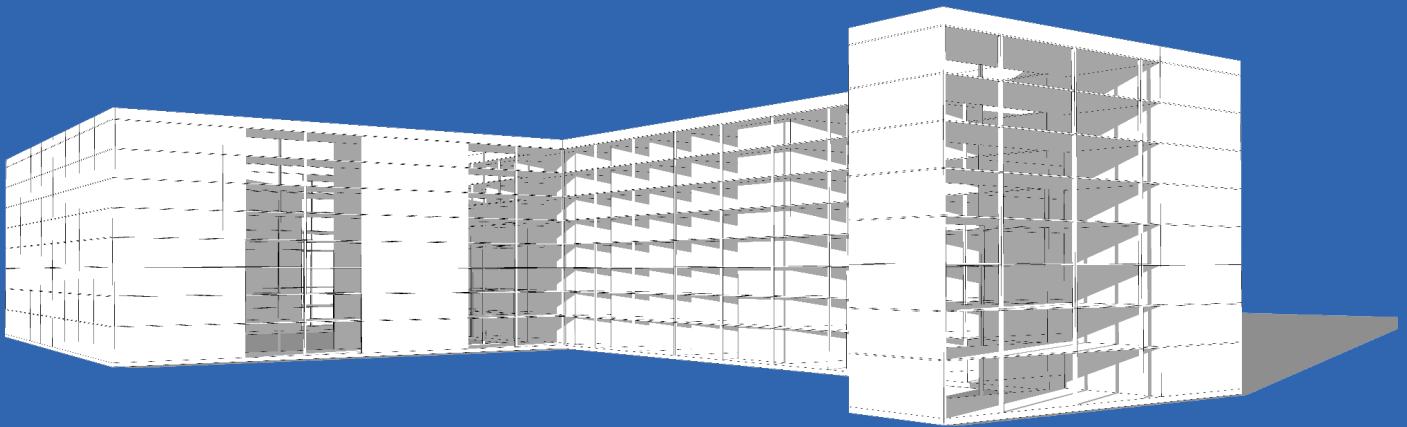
Vista esquemática de la estructura del proyecto utilizando muros de hormigón armado.
